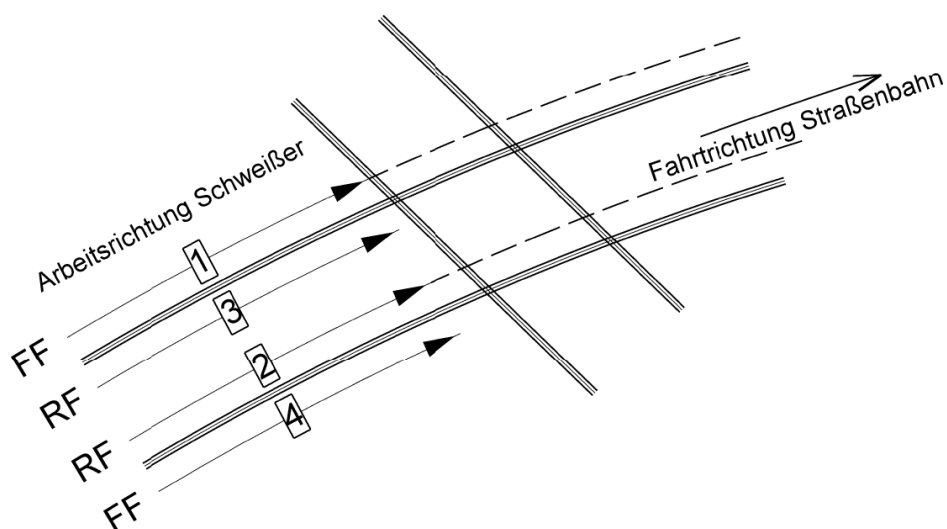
Beispiel der Aufschweißung an der Fahrflanke einer Flachrillenkreuzung
